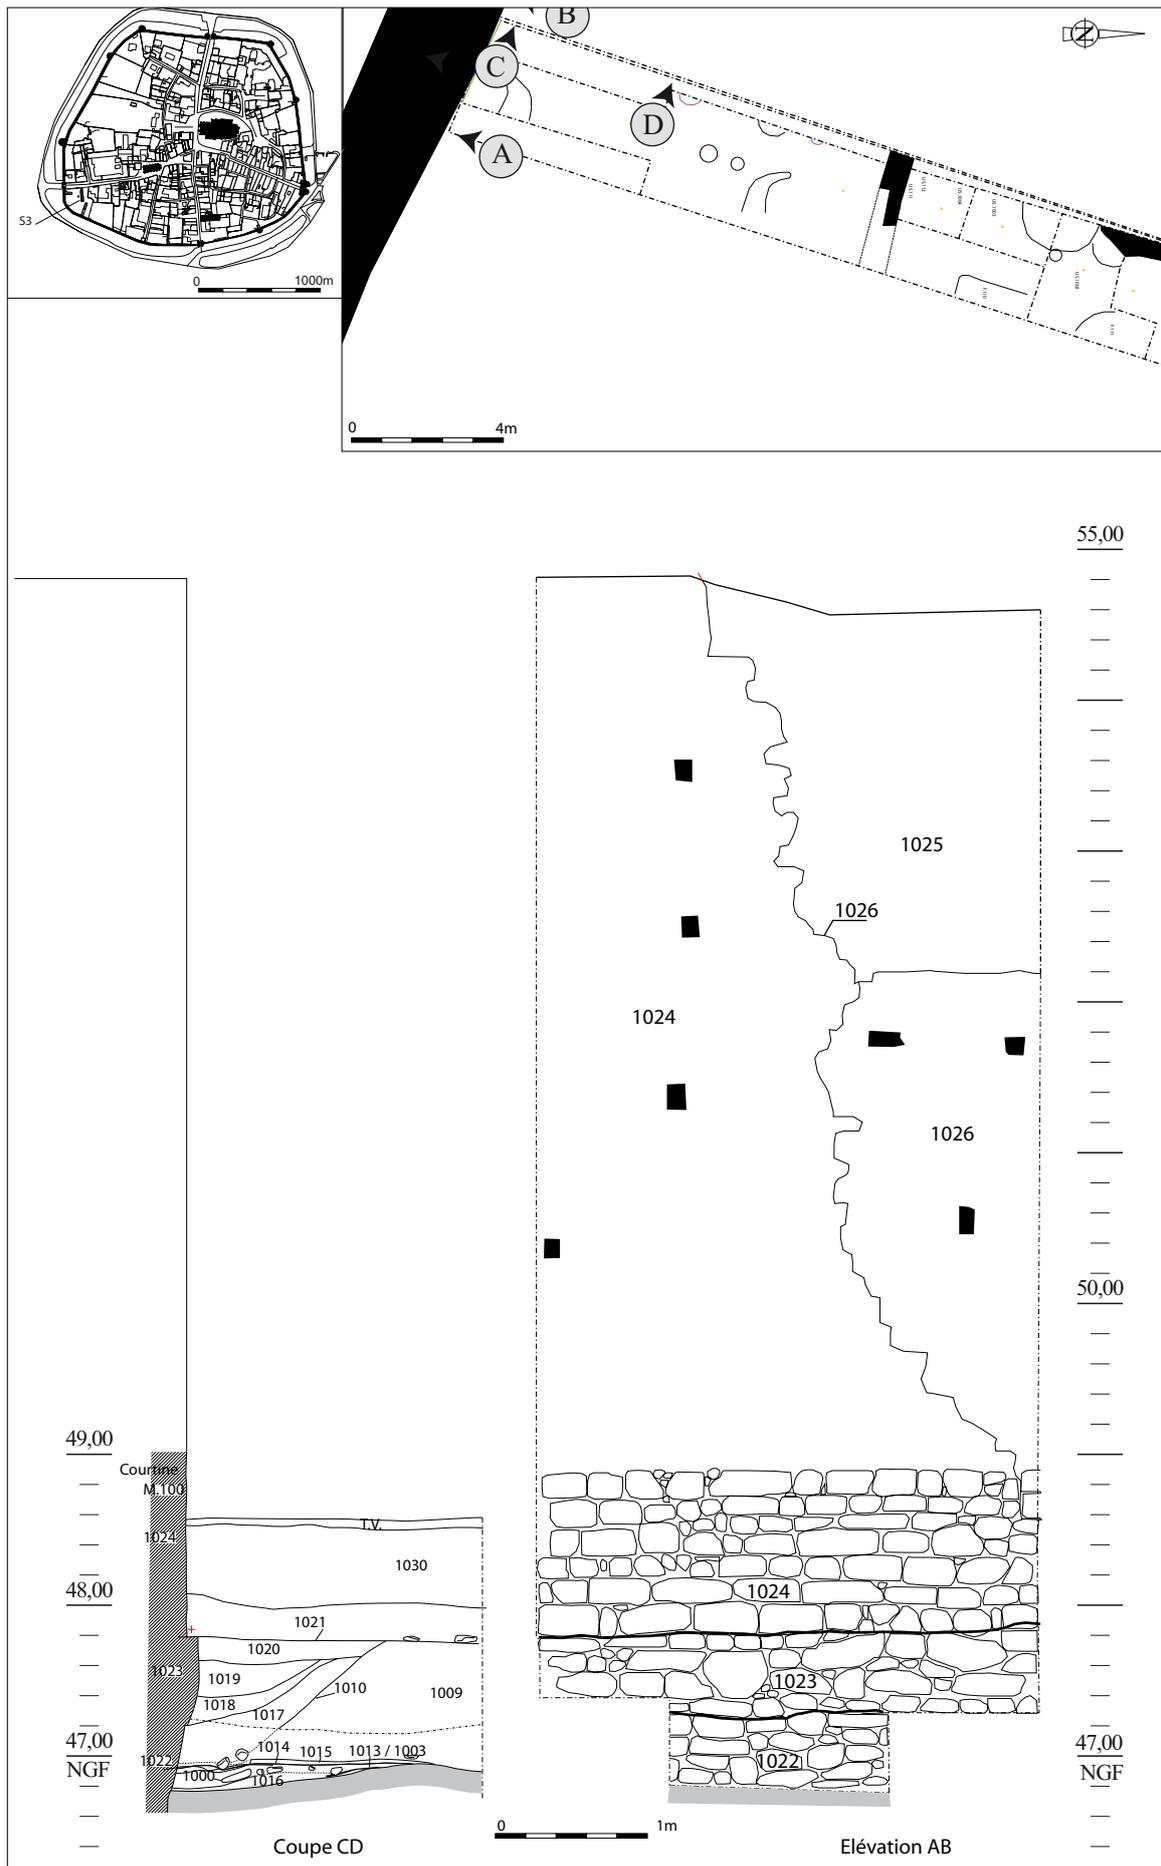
Plan et coupe de la fondation de la courtine découverte à l'extrémité sud du sondage 1 (DAO, Jocelyn Martineau, Antoine Le Boulaire, Inrap).
